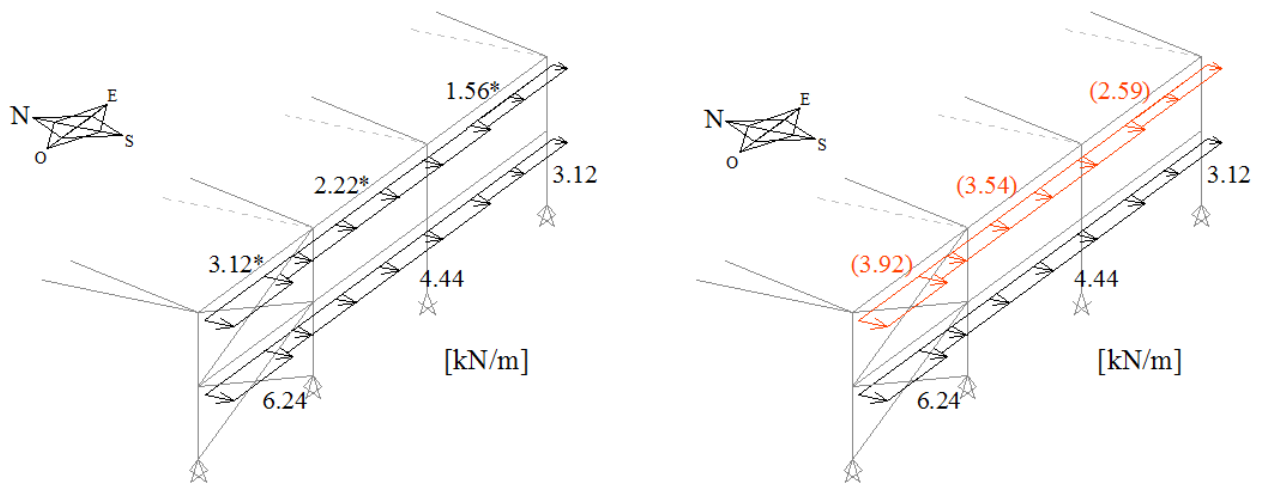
Vento W2 na fachada orientada a Sul na situação 1 (EC1.1.4)
